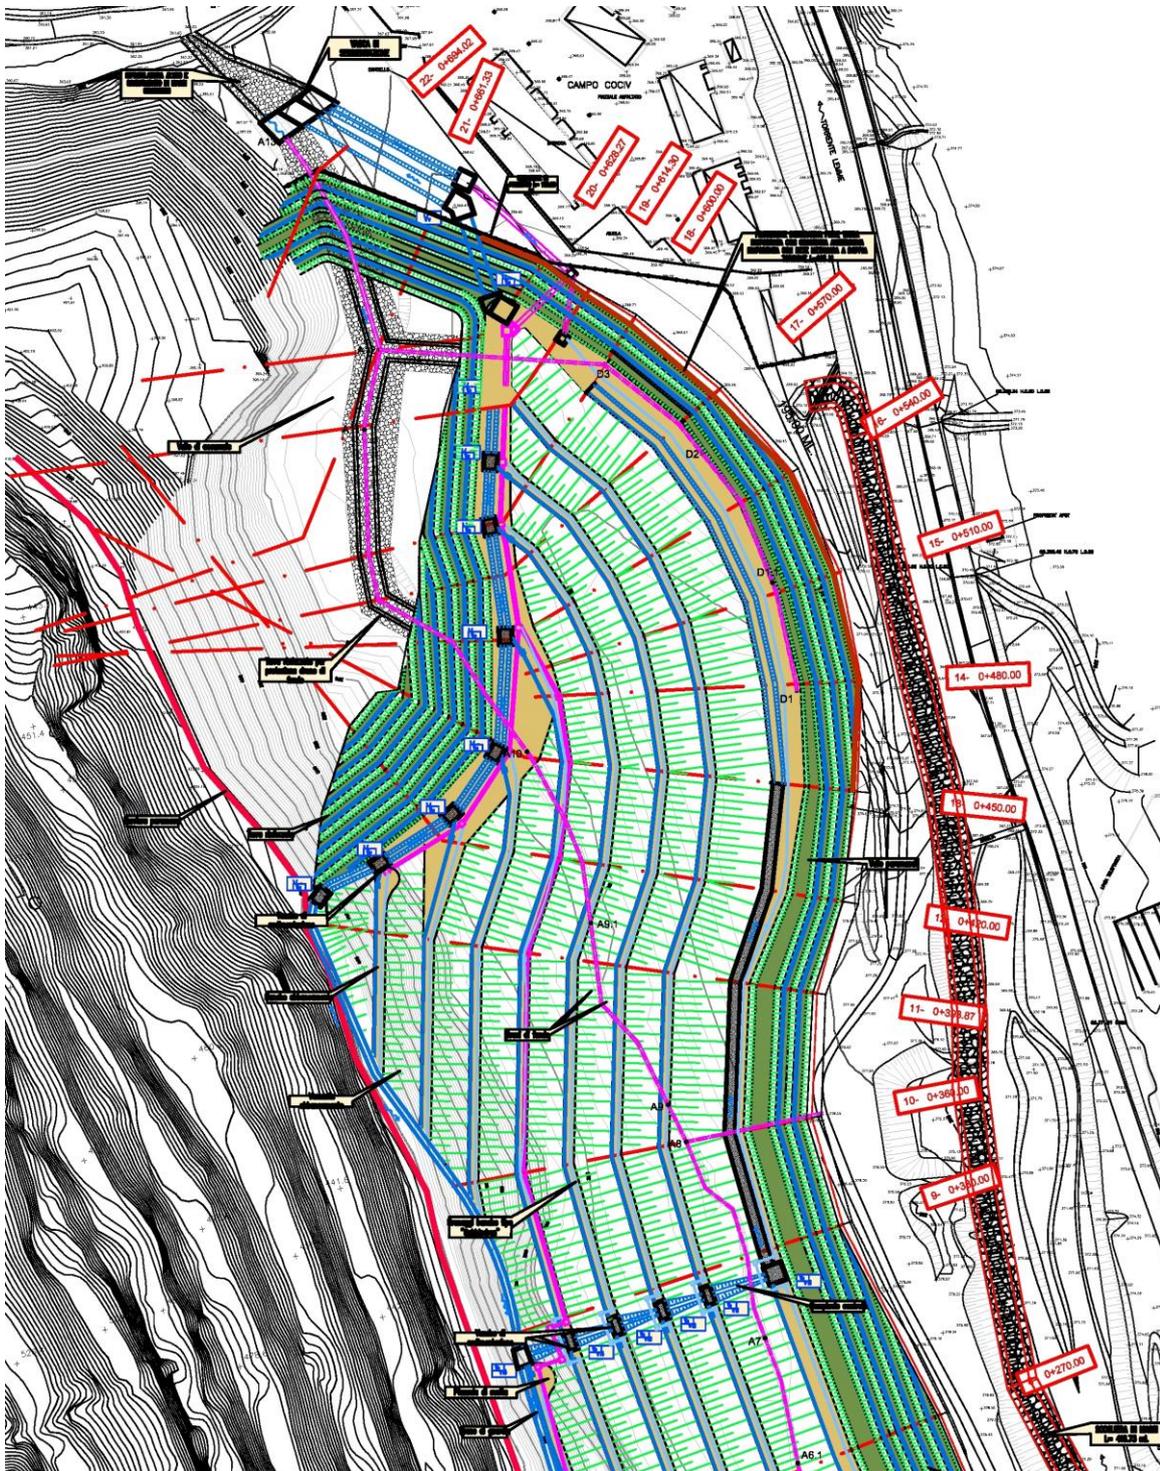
Planimetria con ubicazione della vasca di accumulo
